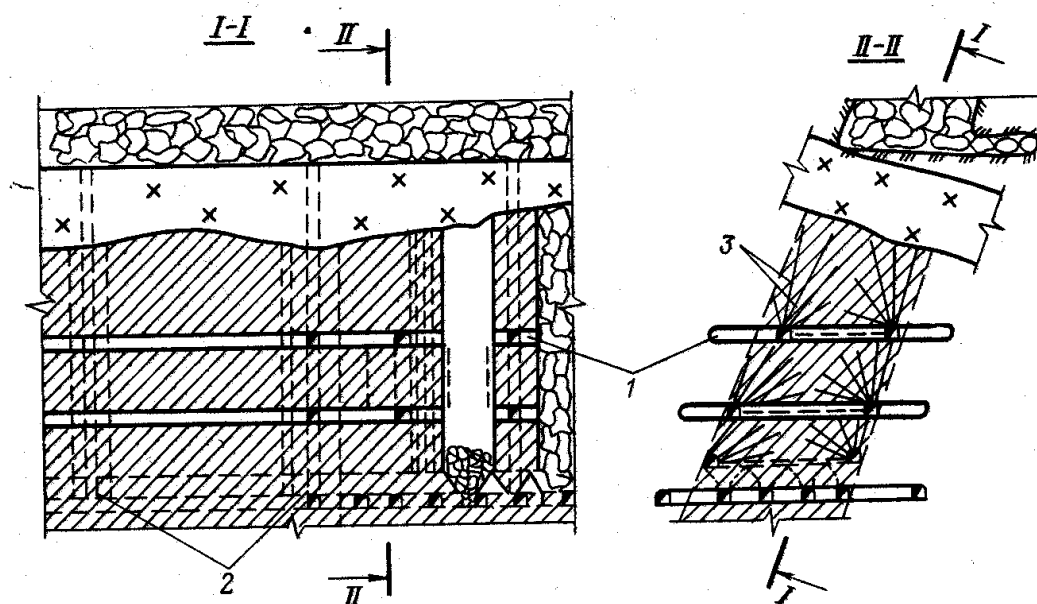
Система разработки подэтажными штреками с magazинированием руды:
